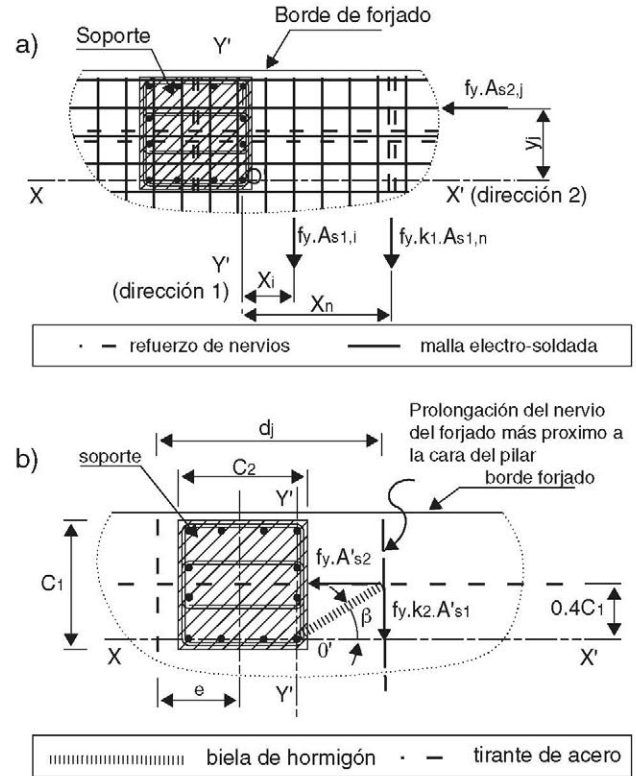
Mecanismo biela-tirante: a) armado superior; b) armado inferior.
